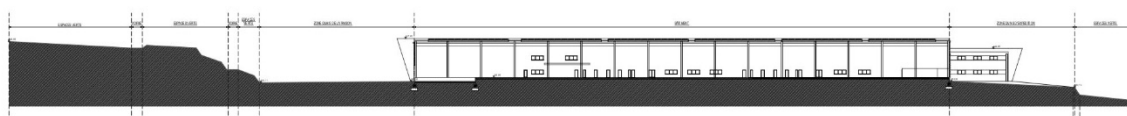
Coupe terrain longitudinale (Source : notice architecturale architecture ABC)
